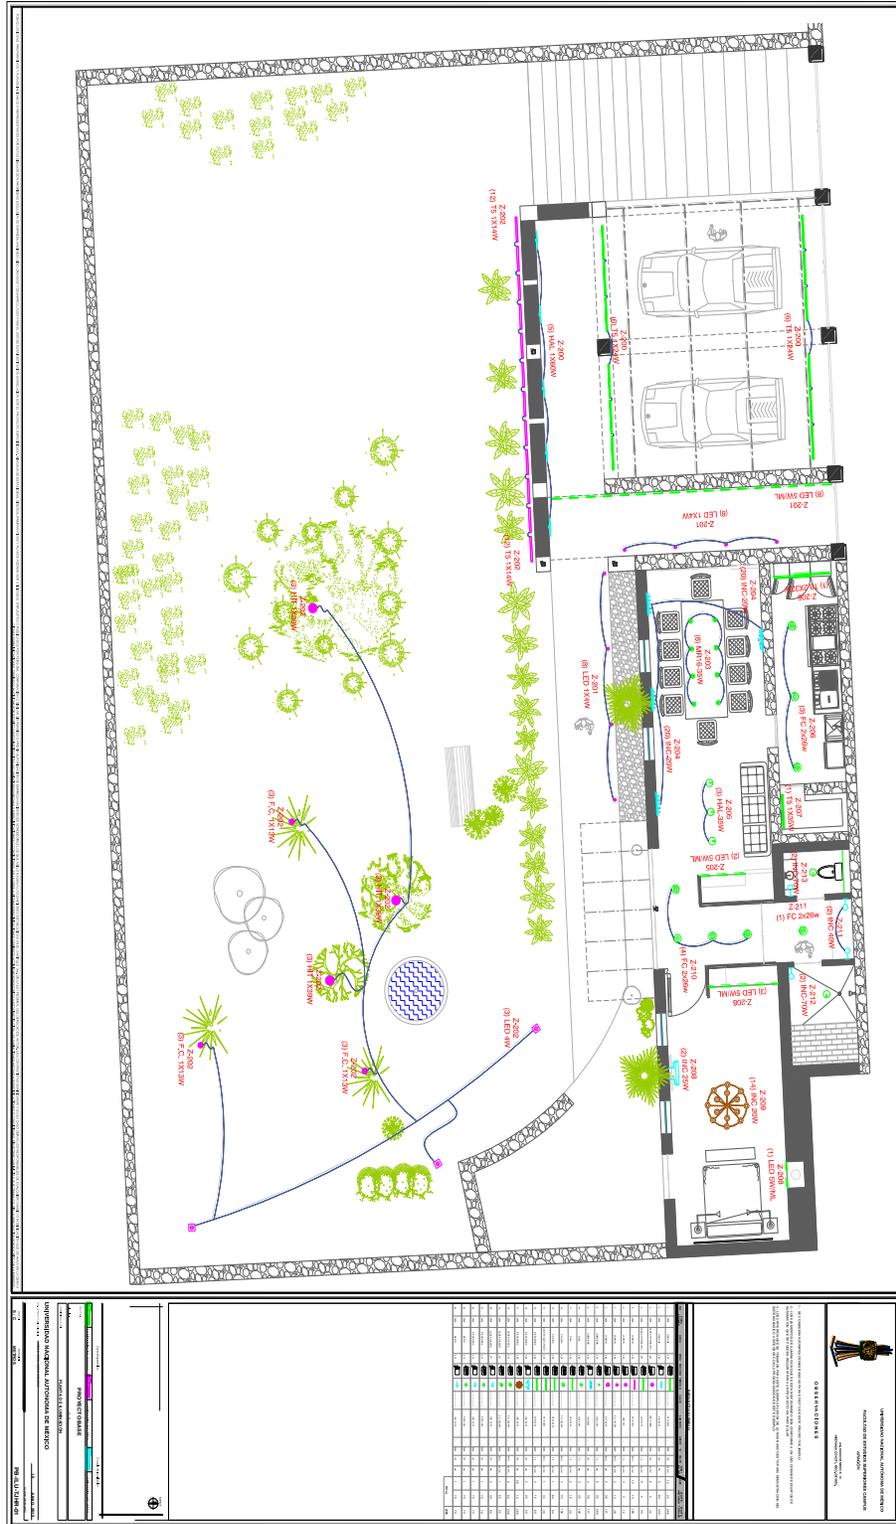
Plano de proyecto para zonificaciones de alumbrado
